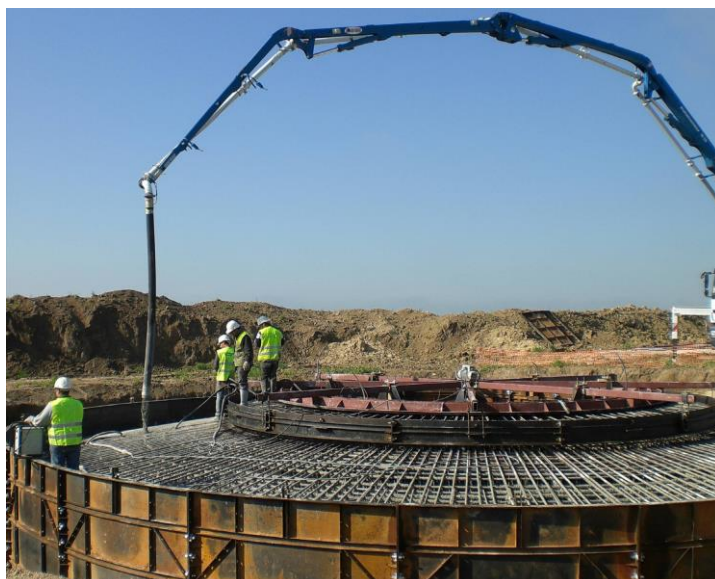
Exemple d'excavation d'une fondation d'éolienne (Parc éolien de l'Herbissonne
